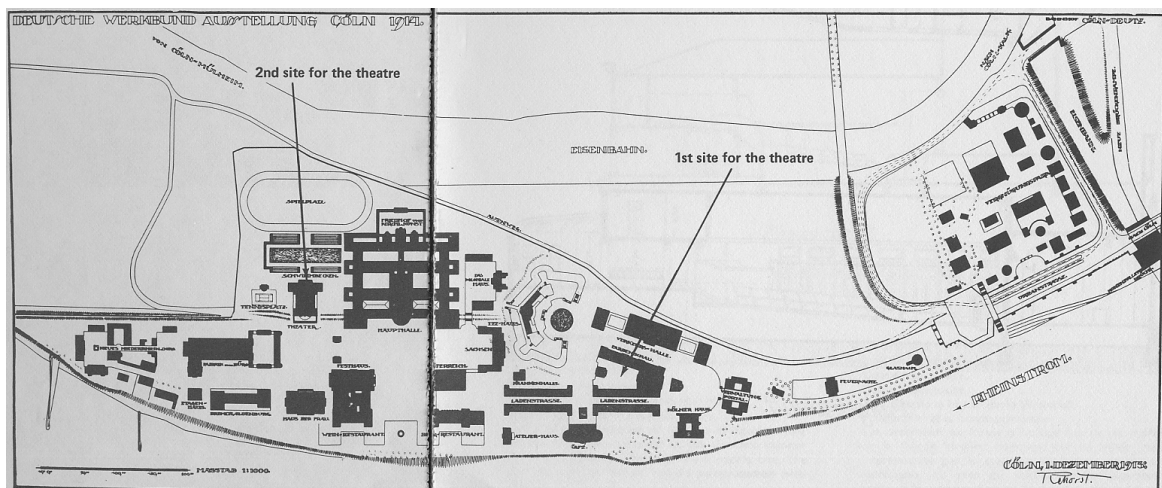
Planimetria dell'esposizione del Werkbund, Colonia, 1914.
